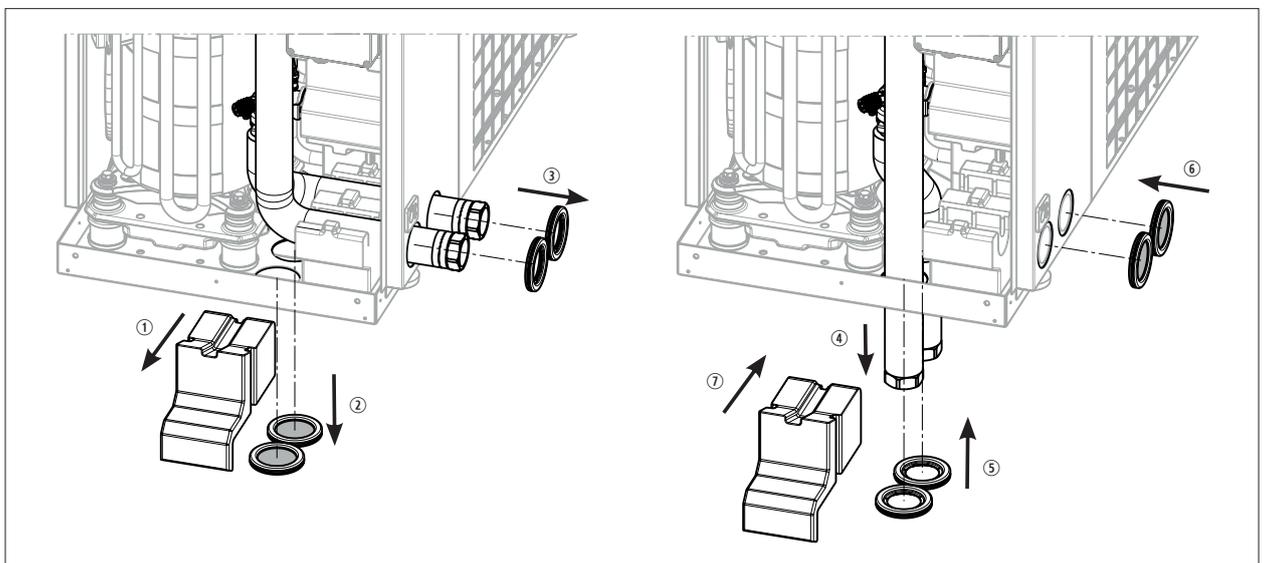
Spostare i collegamenti idraulici dell'unità esterna
